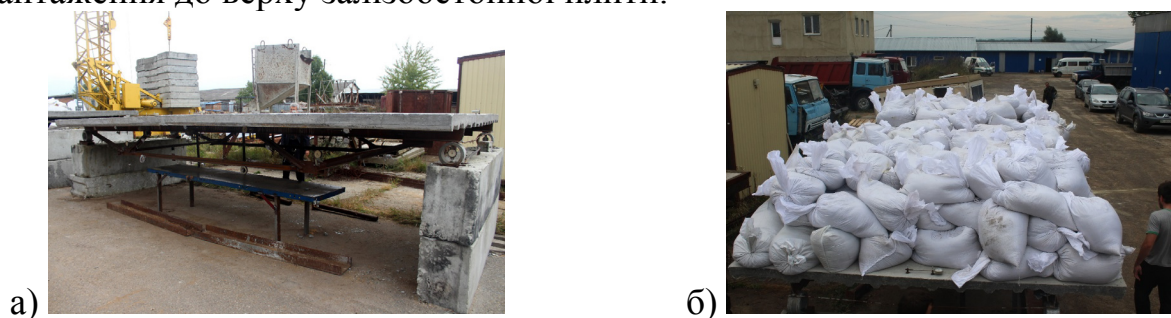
Дослідна шпренгельна сталезалізобетонна конструкція:
